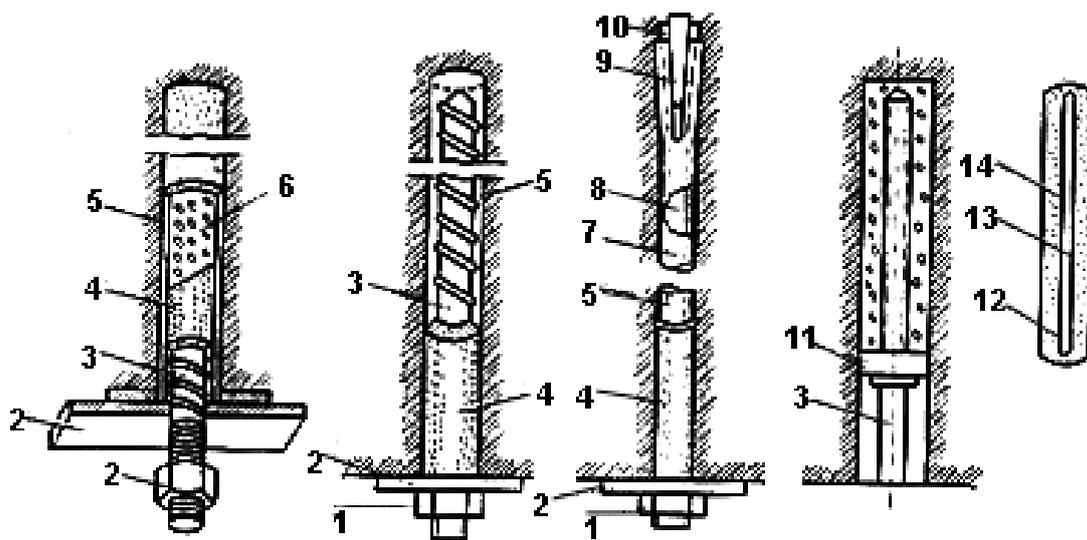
Типы анкеров: а – железобетонный перфоанкер; б – железобетонный забивной; в – железобетонный трубчатый; г – металлический анкер, закрепленный искусственной смолой; д – стеклянная ампула со смолой для анкера типа «г»; 1 – гайка; 2 – опорная плитка; 3 – металлический стержень анкера; 4 – цементно-песчаный раствор; 5 – шпур; 6 – трубка с перфорацией;
